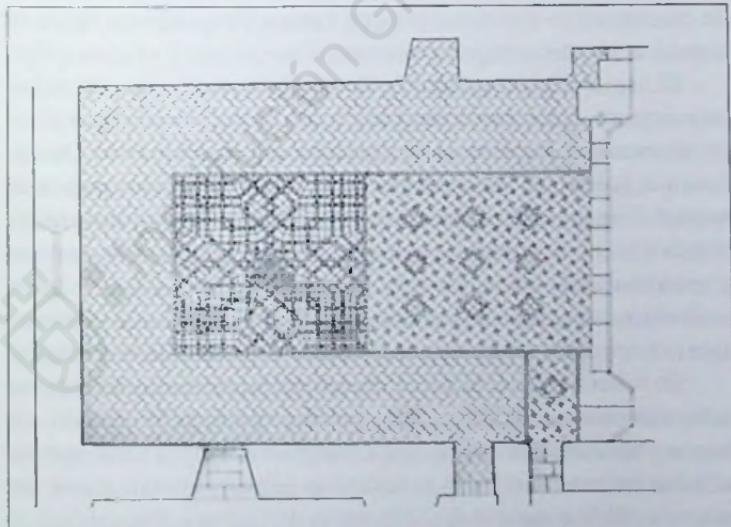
Proyecto del pavimento del coro (José Ramón Duralde).
